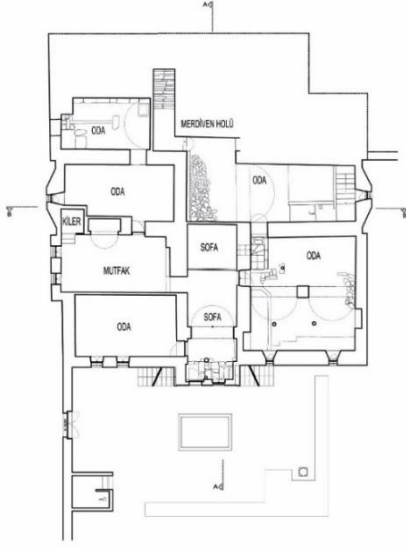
Vaziyet planı (Tavacıgil, 2007b)
